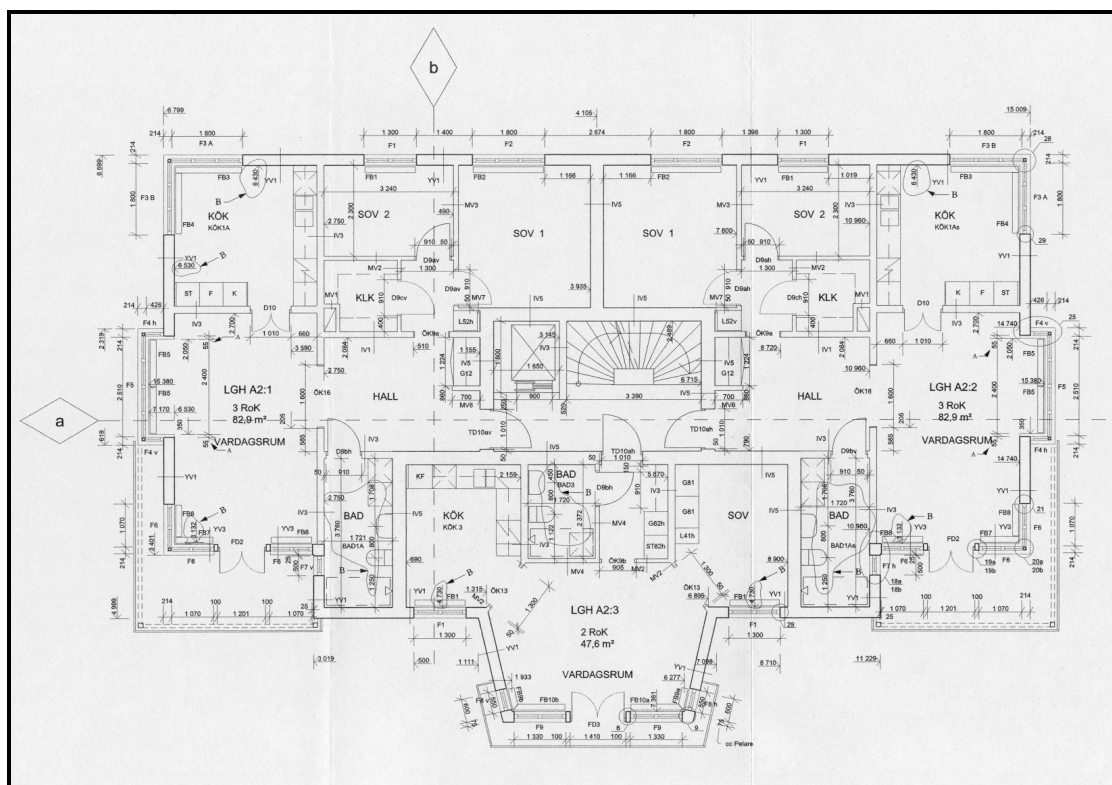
Typvåningsplan Brf. Runhällen. (För fasad – se Bällstalund)
